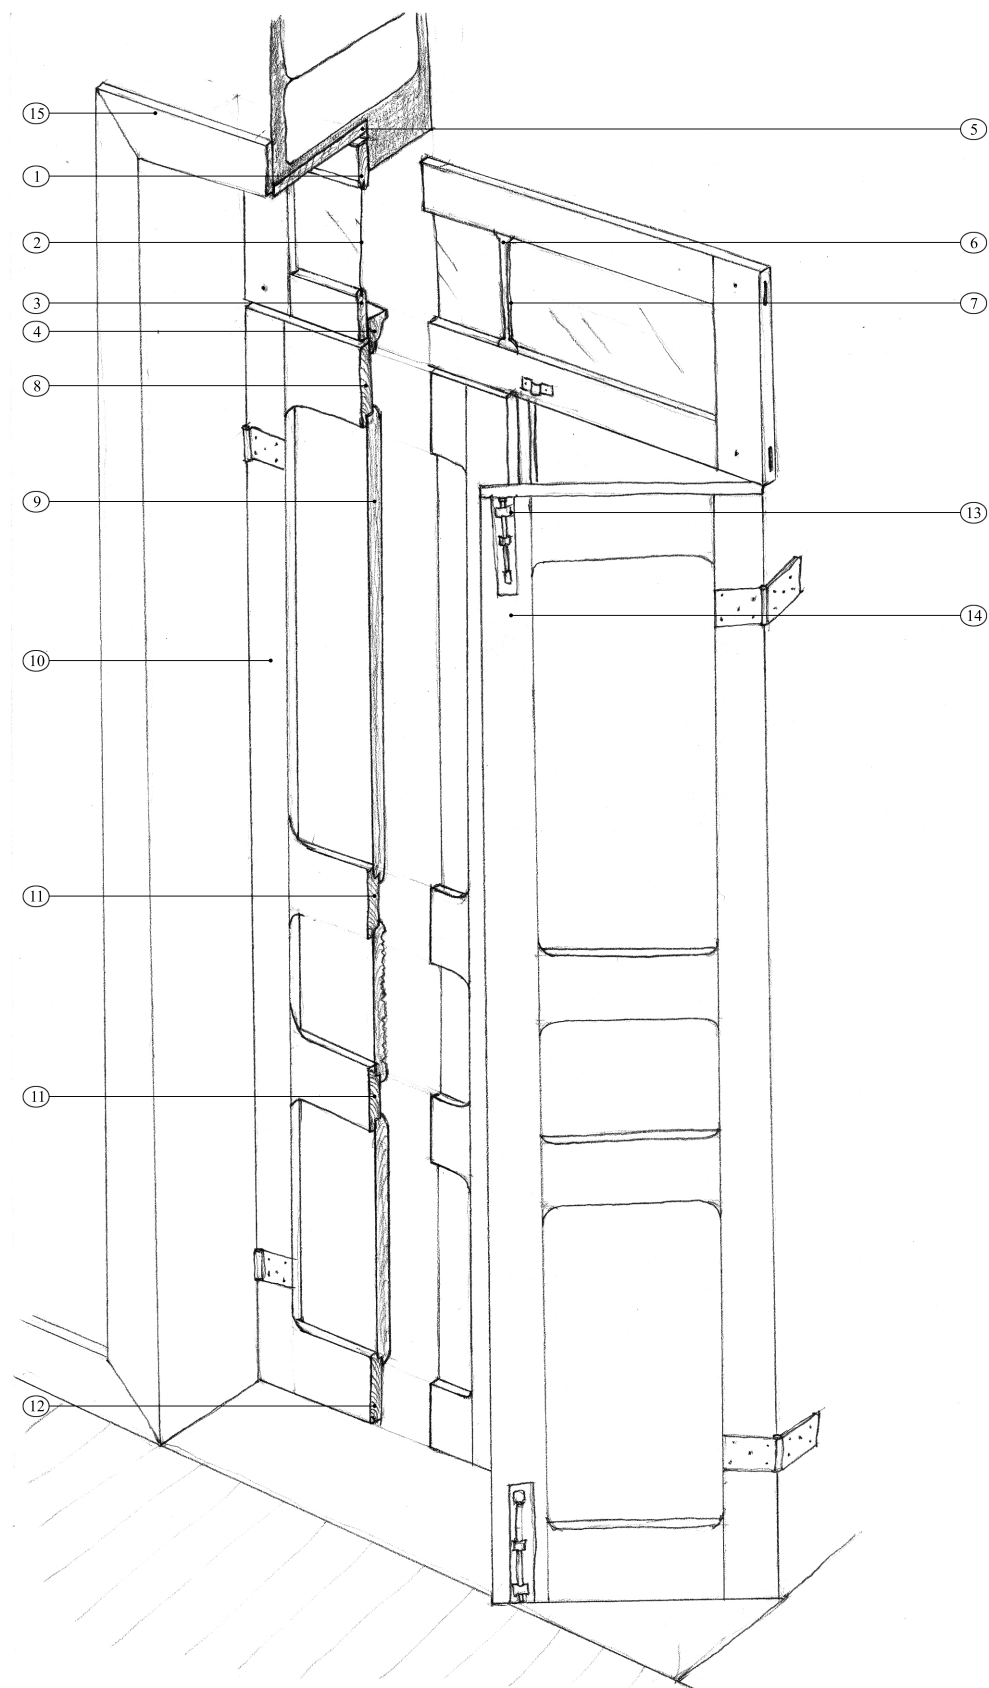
Corte tipo de porta de duas folhas, com bandeira. Legenda: 1 Travessa superior do caixilho da bandeira, 2 Vidro, 3 Travessa inferior do caixilho da bandeira, 4 Travessa da bandeira, 5 Aro / Marco, 6 Pinázio, 7 Betume, 8 Travessa superior do caixilho da porta, 9 Almofada, 10 Couceira, 11 Travessa intermédia do caixilho da porta, 12 Travessa inferior do caixilho da porta, 13 Fechadura culatra, 14 Dobradiça, 15 Alizare.
